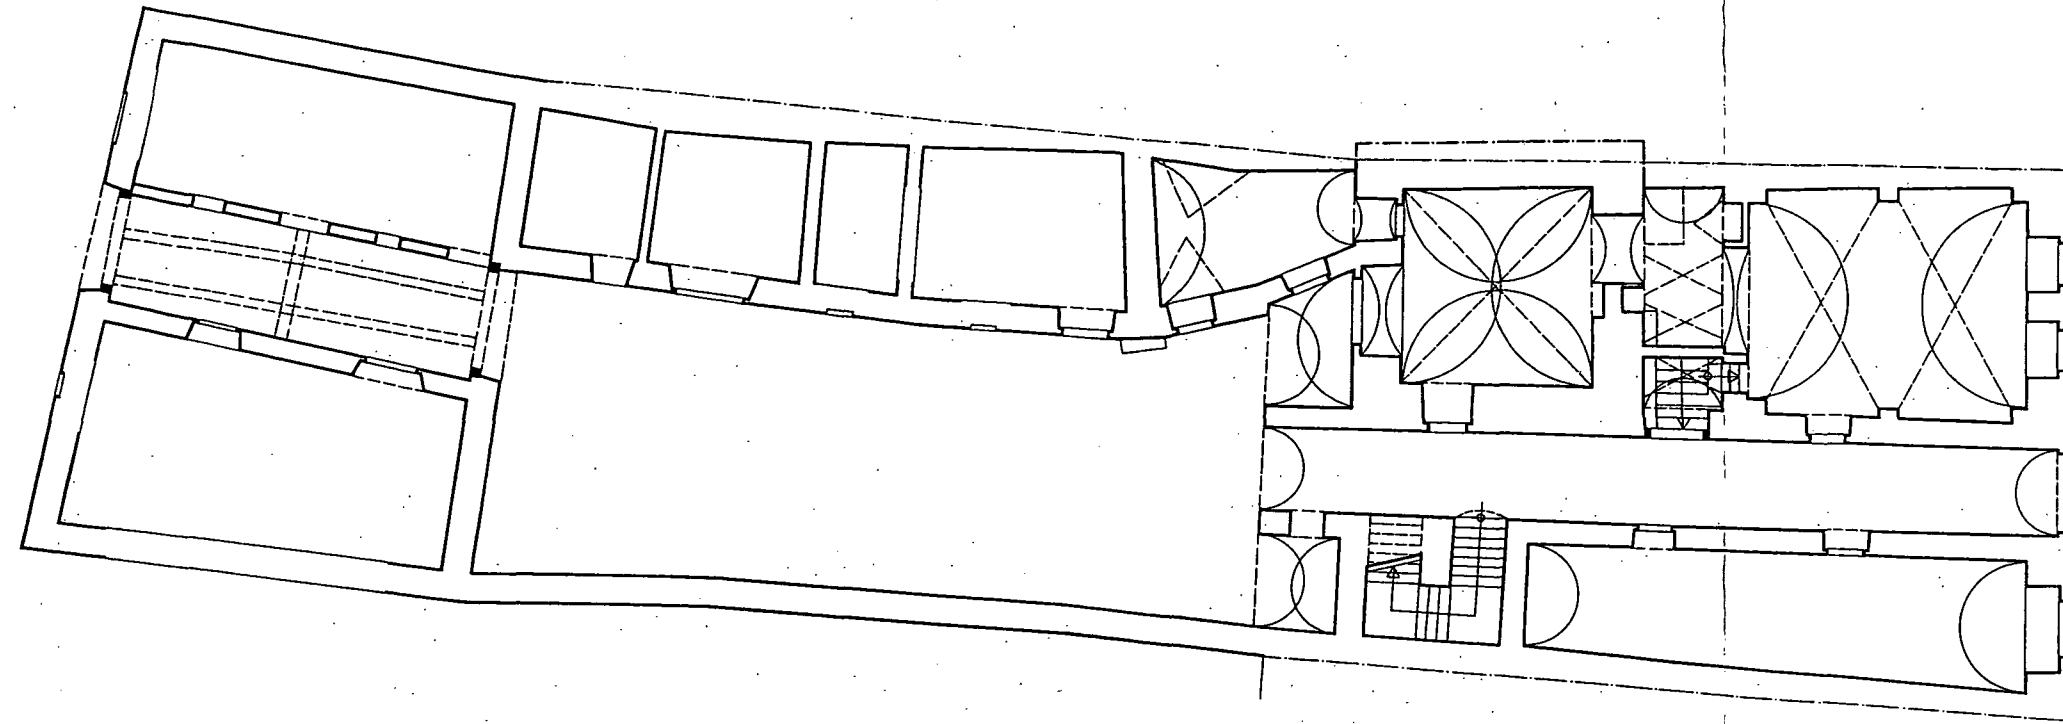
Stadtplatz 29 – Grundrisse Keller, Erdgeschoss (1:200).
